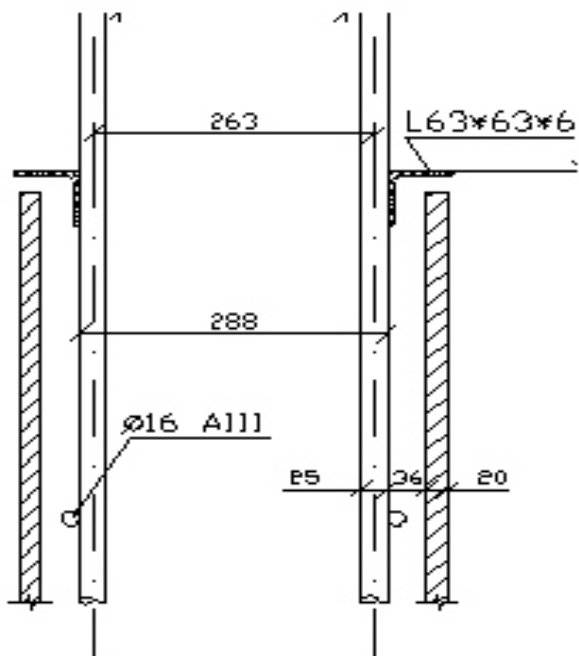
Узел армоблока стены с уголками, обеспечивающими опирание армоблока
